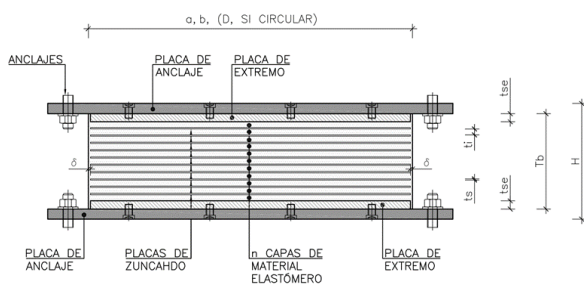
Alzado tipo de un aislador LDRB con anclaje normalizado mediante tornillos
